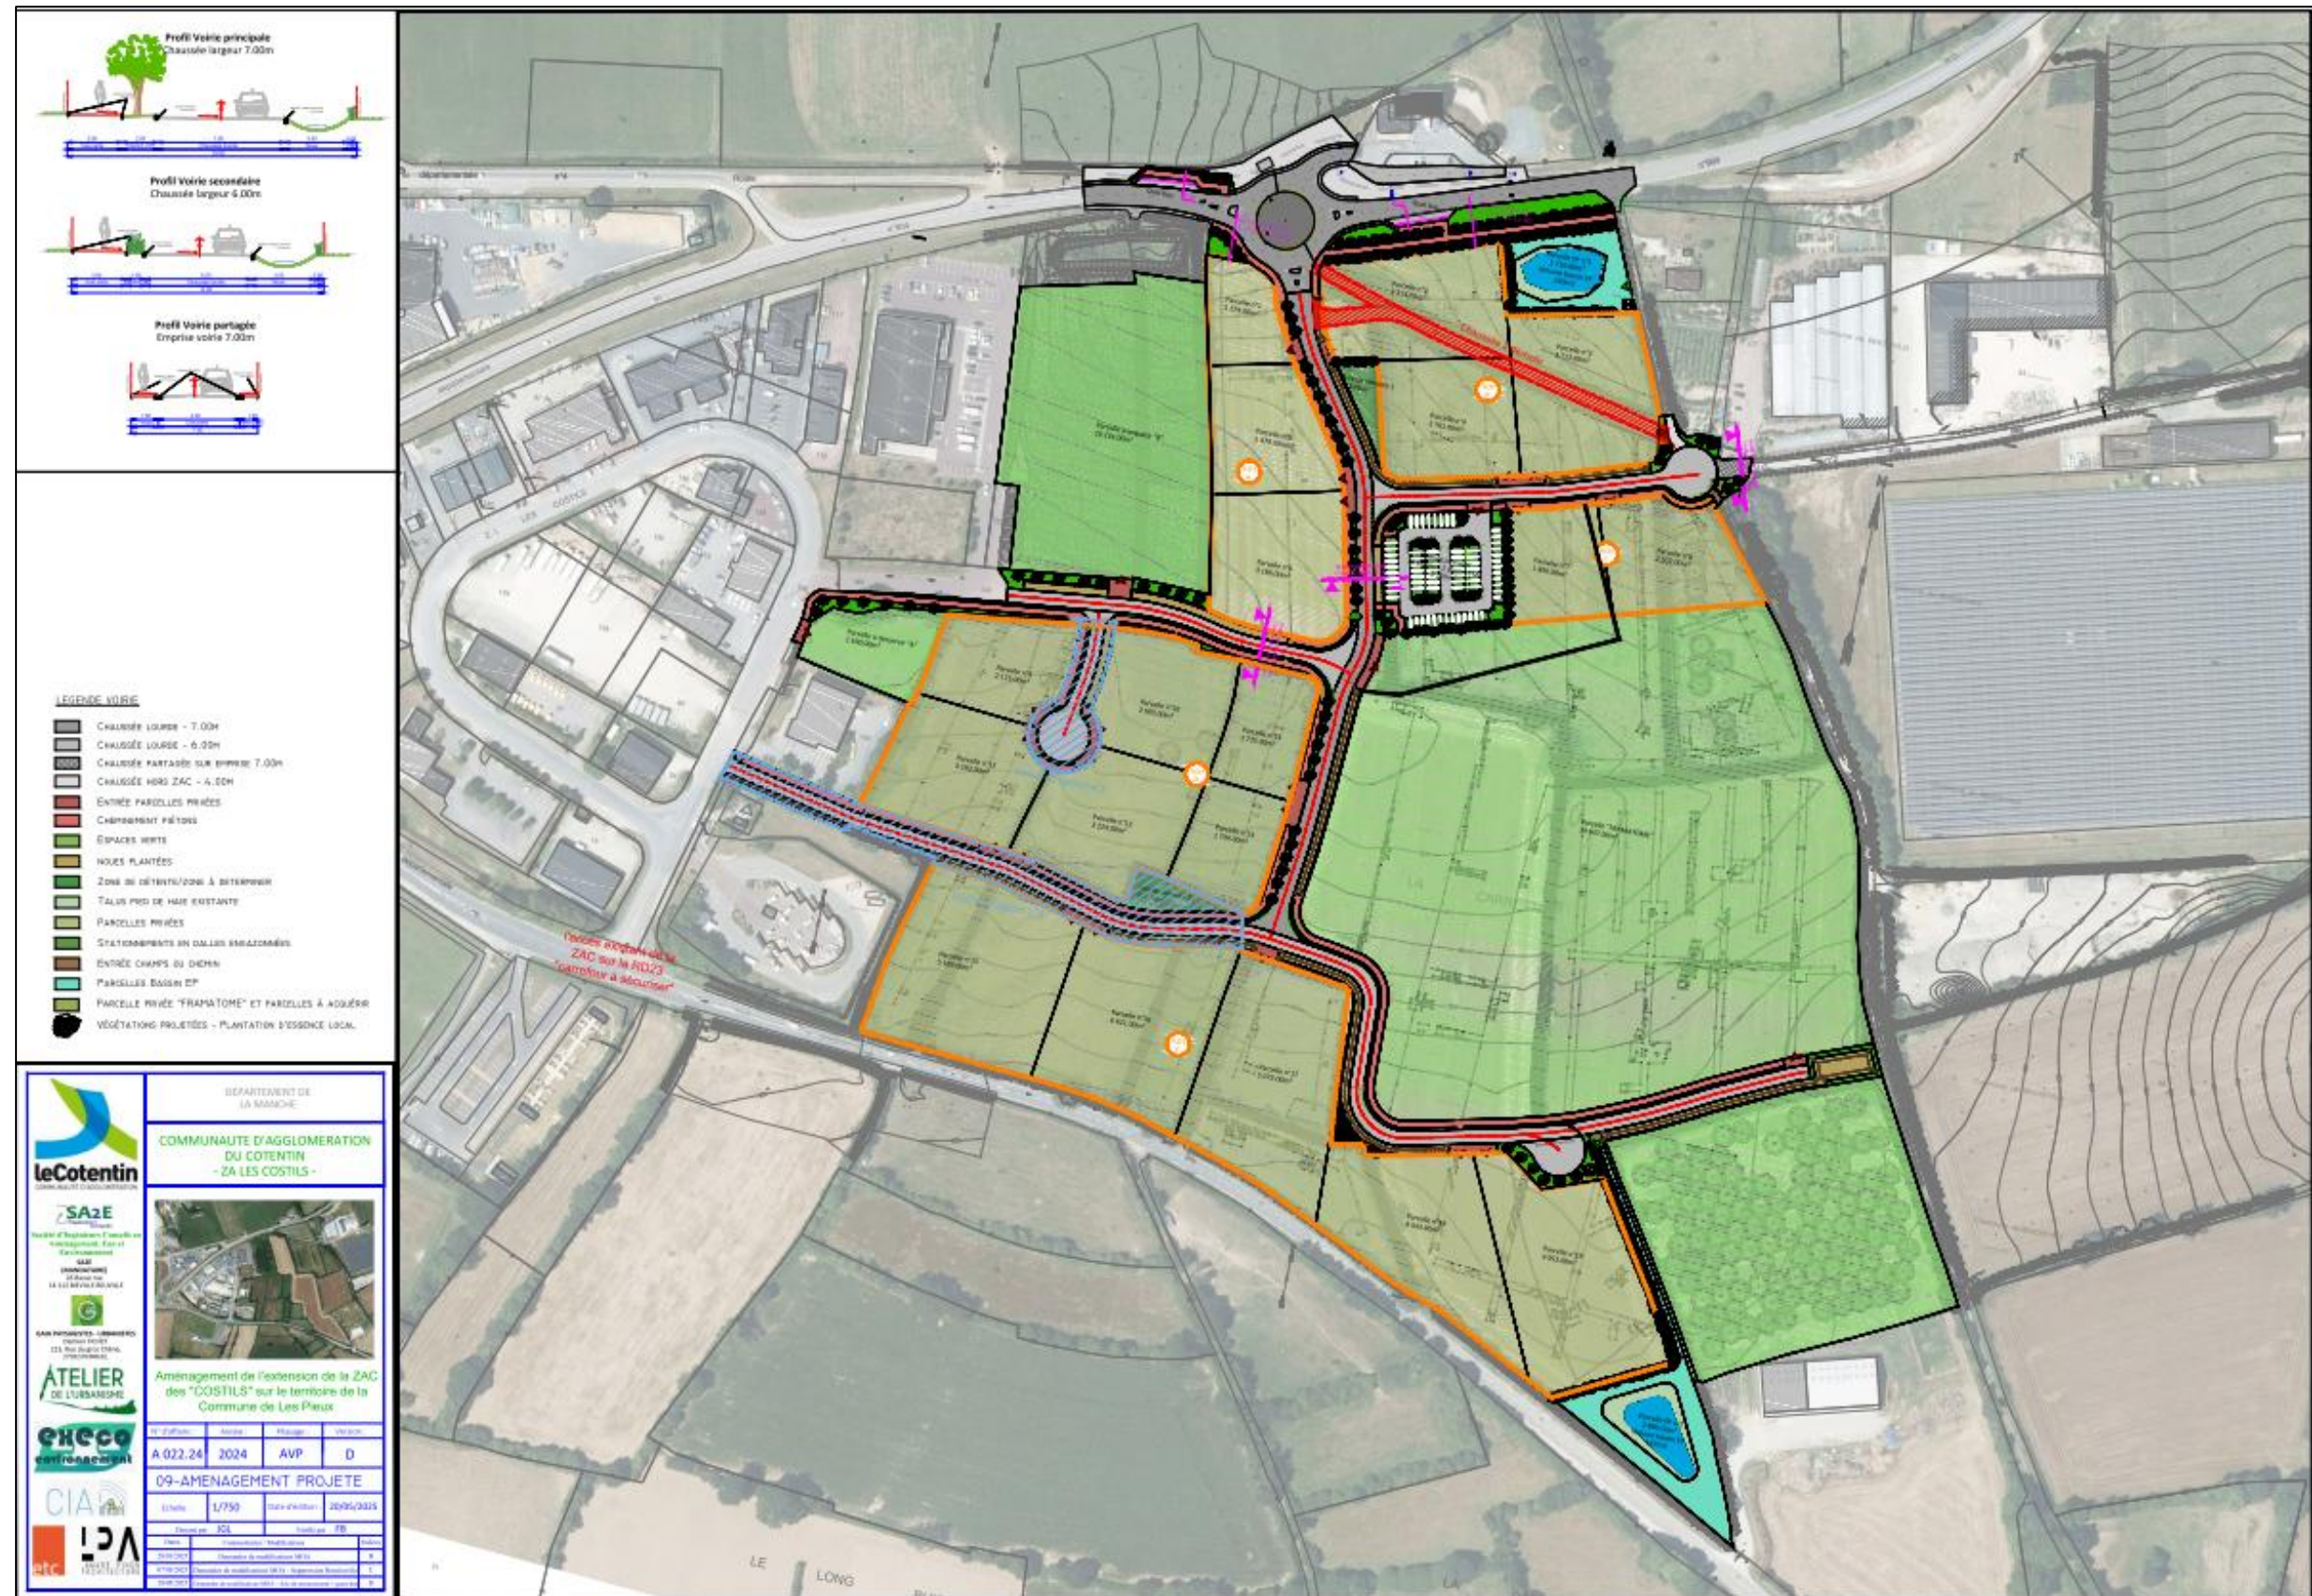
Plan du projet d'extension de la ZA des Costils aux Pieux (50)
